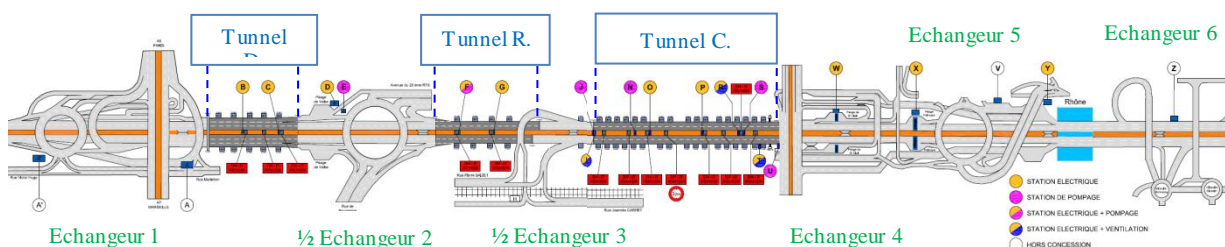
Tracé de l'ouvrage routier schématisé, comprenant les 3 principaux tunnels
